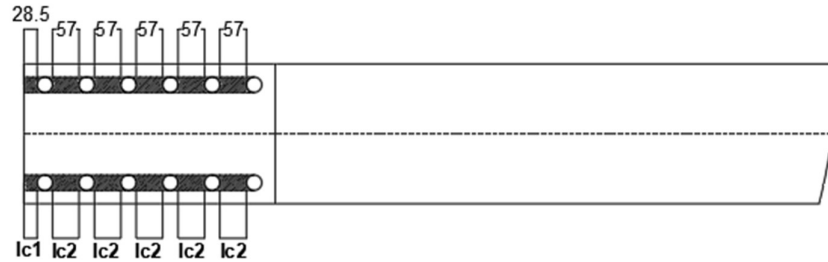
64 Tampakk Melintang Konfigurasi Sambungan Baut
